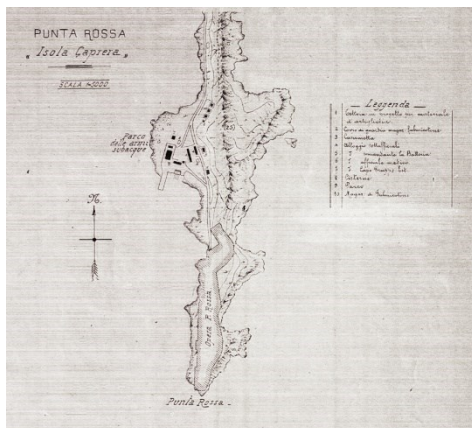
Planimetria di Punta Rossa, 1922 (AS Genio Militare di La Maddalena)
